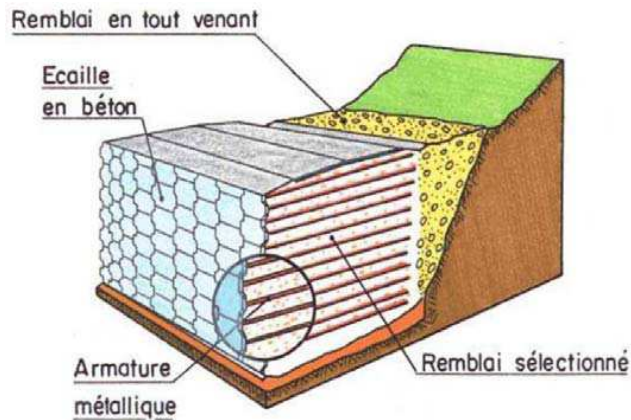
Exemple de remblai en Terre Armée [SET79]
